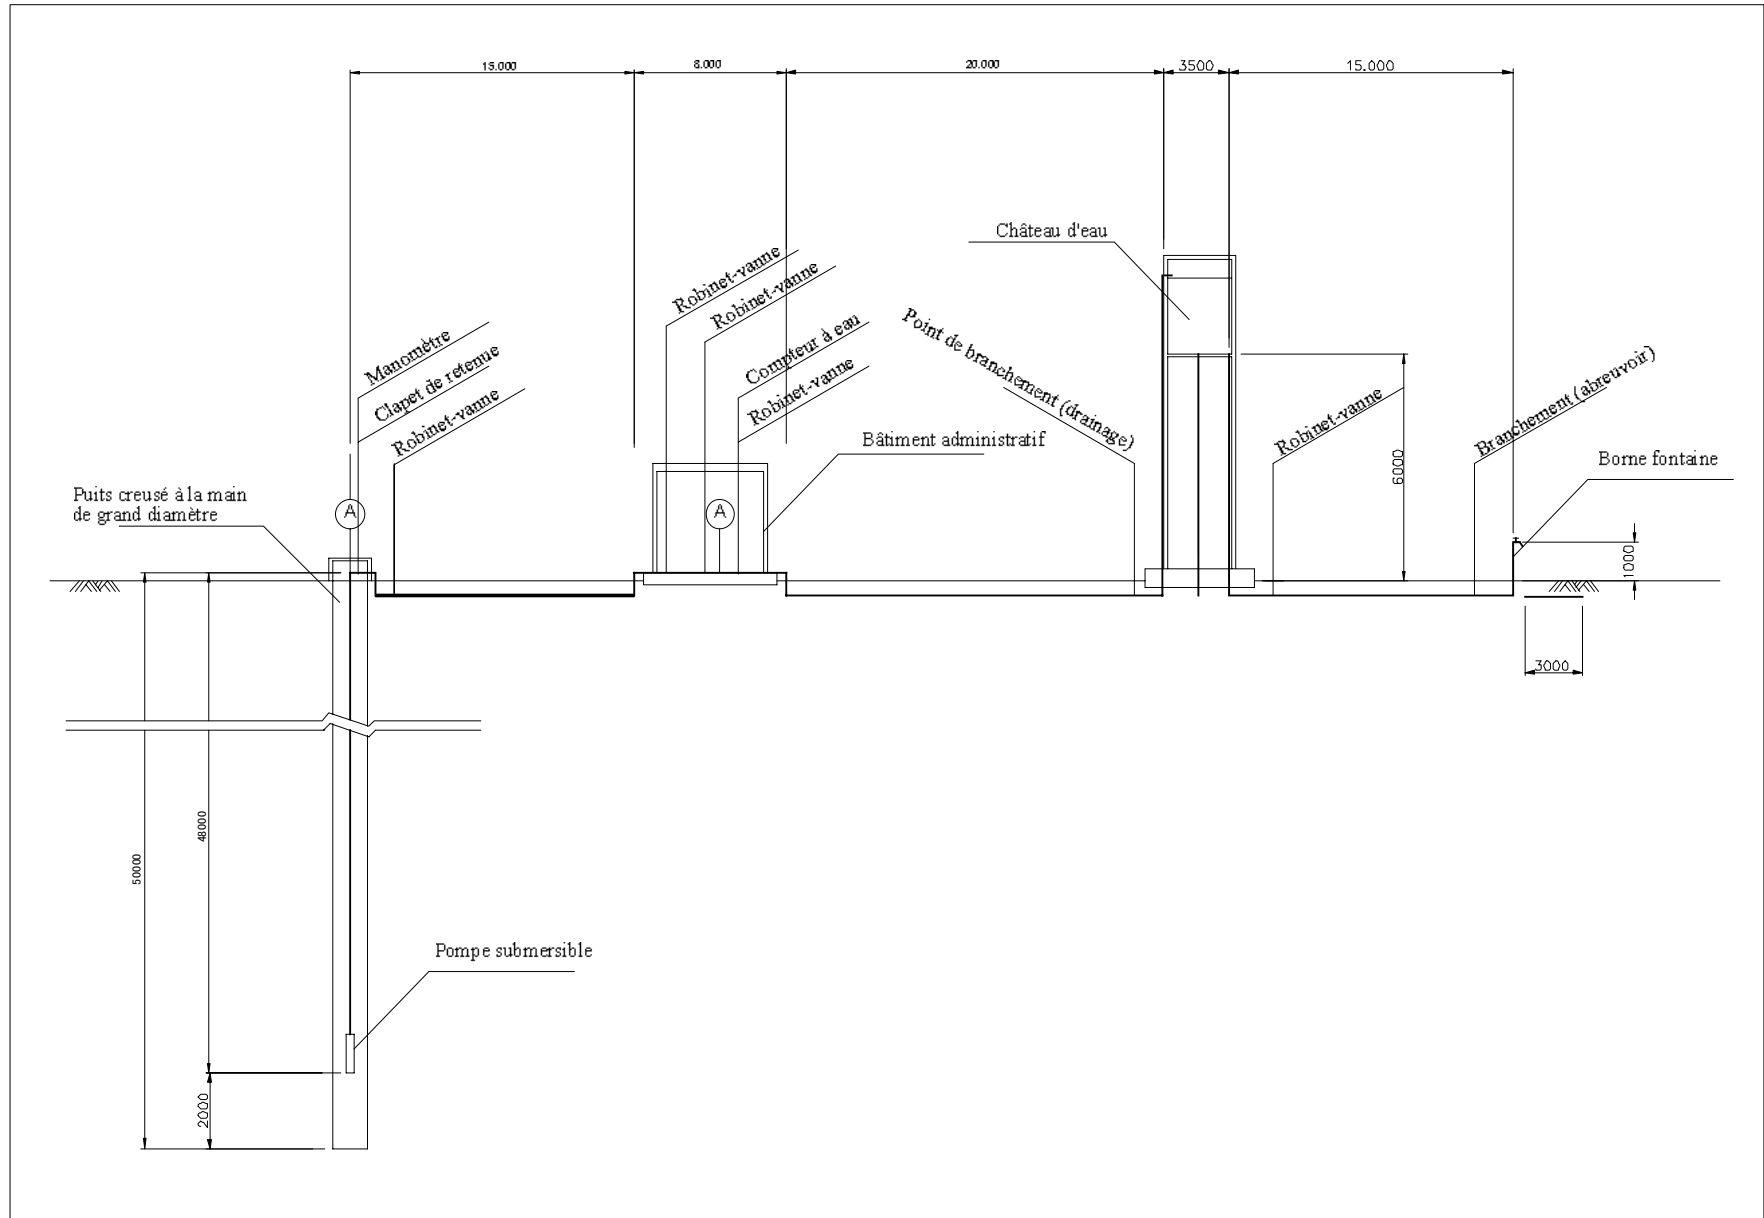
Profil en long des installations d'alimentation en eau potable
